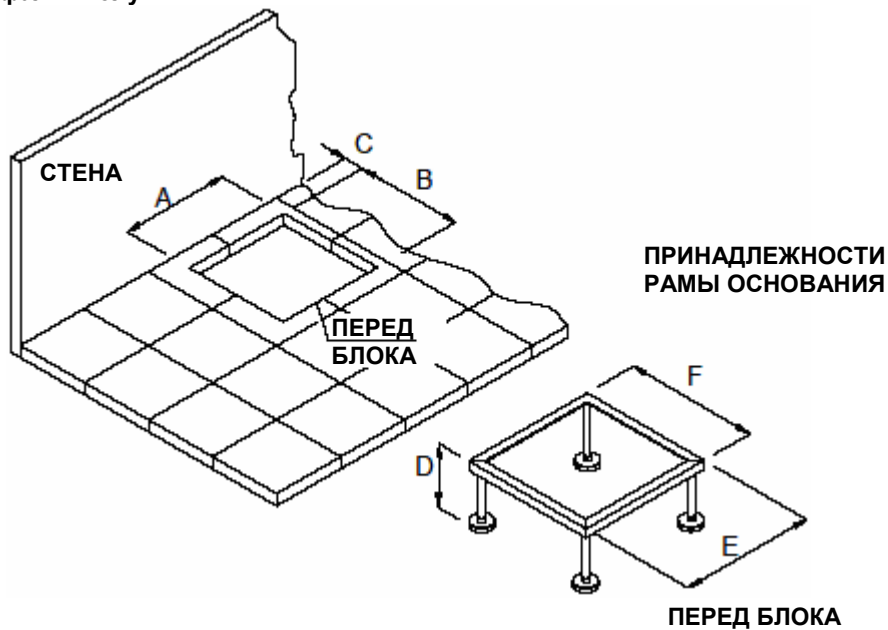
Вход и выход воздуха – отверстия для подсоединения пленума
